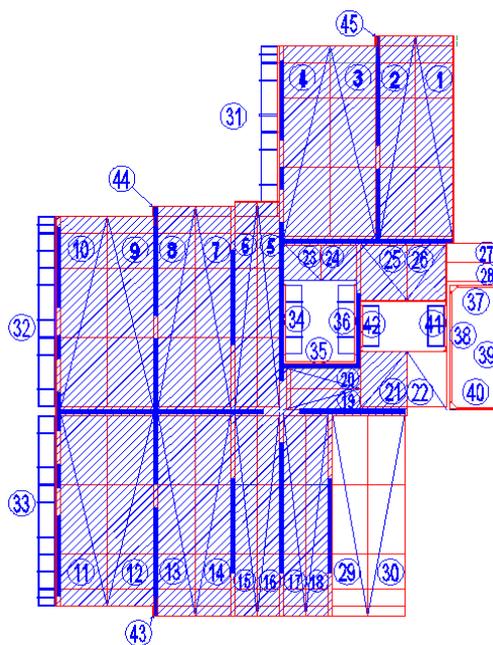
Primeiro ciclo de concretagem de um pavimento
